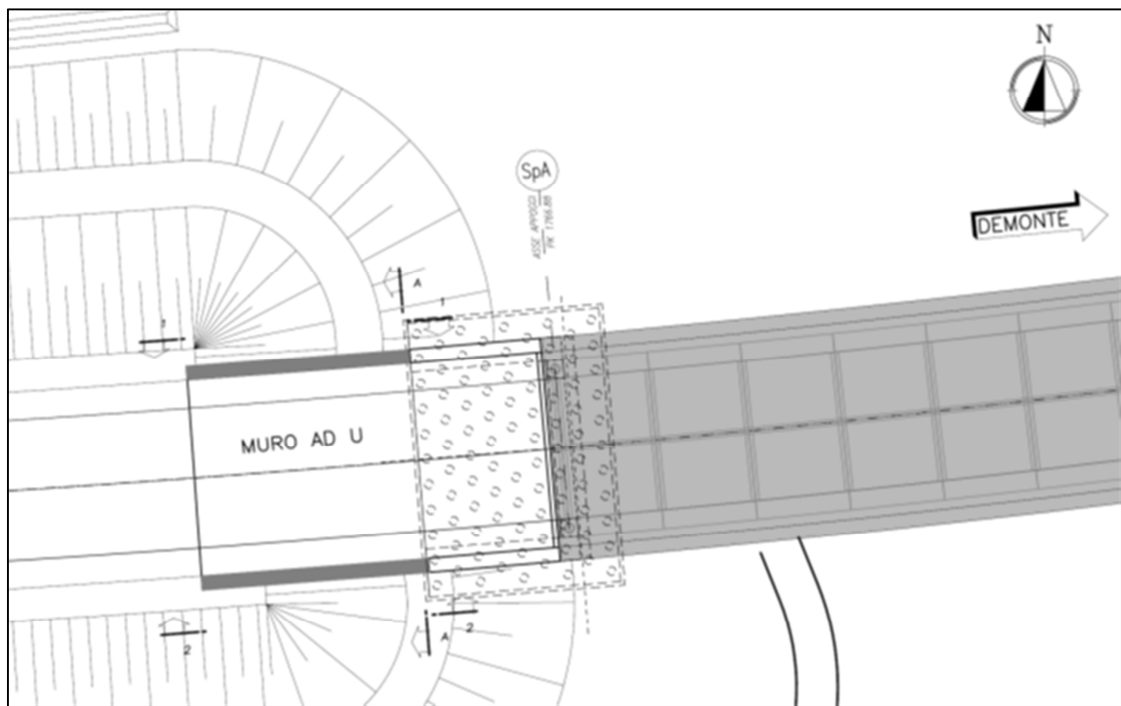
Planimetria ed ubicazione Muro andatore
